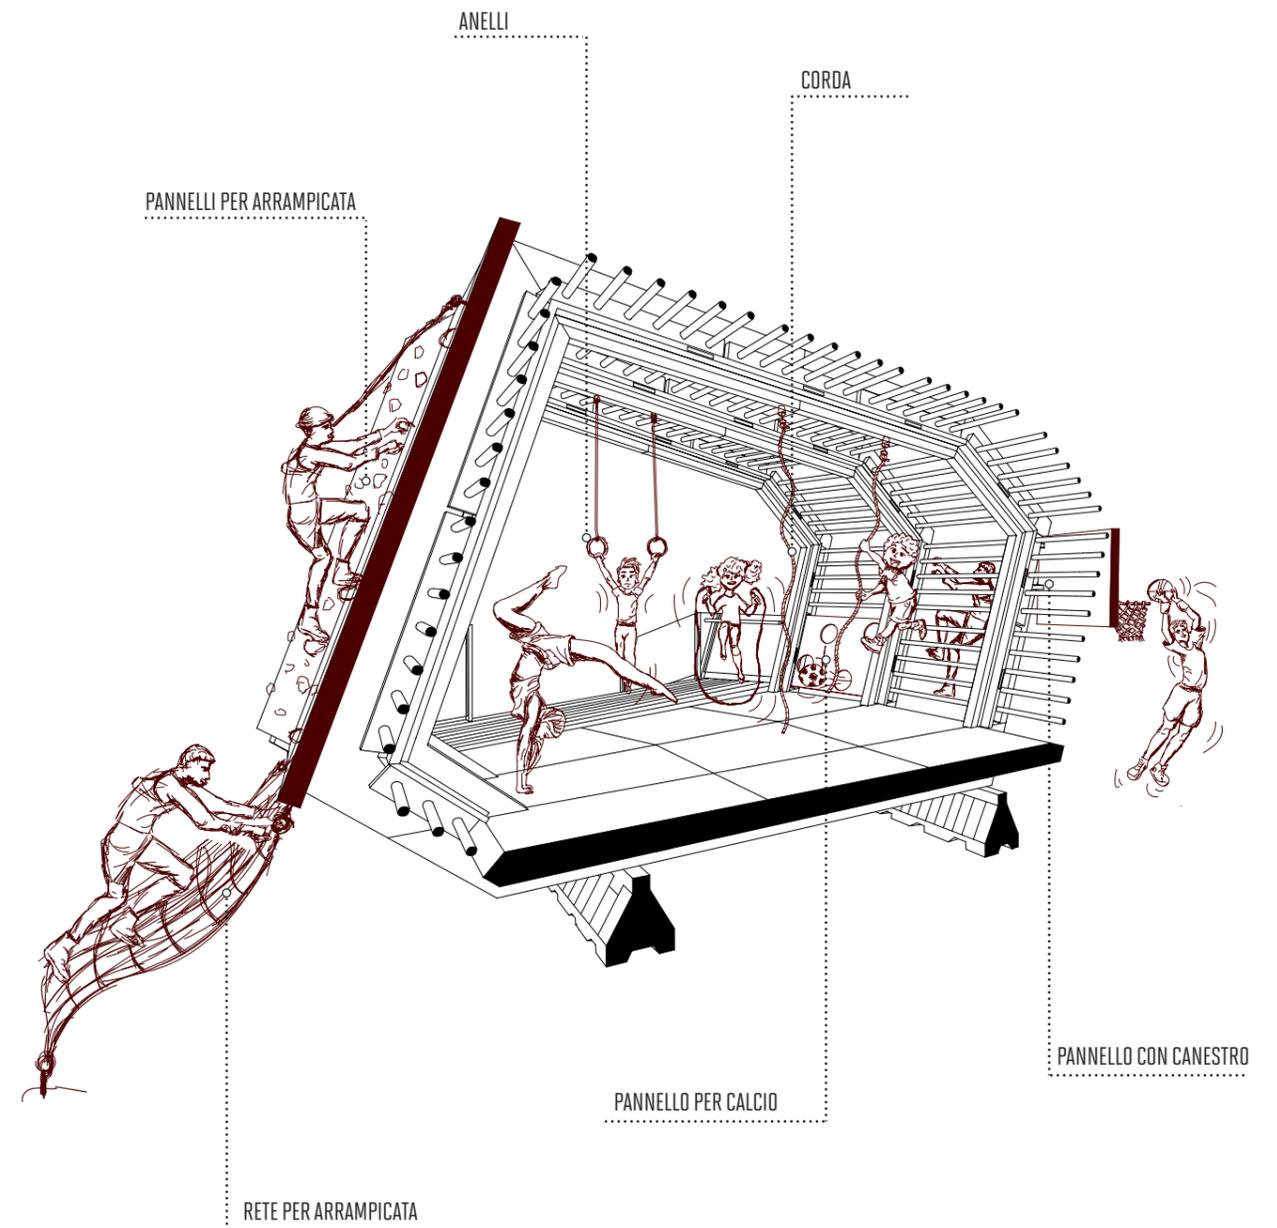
SEZIONE PROSPETTICA DEL BOX ARREDATO COME PLAYHOUSE
